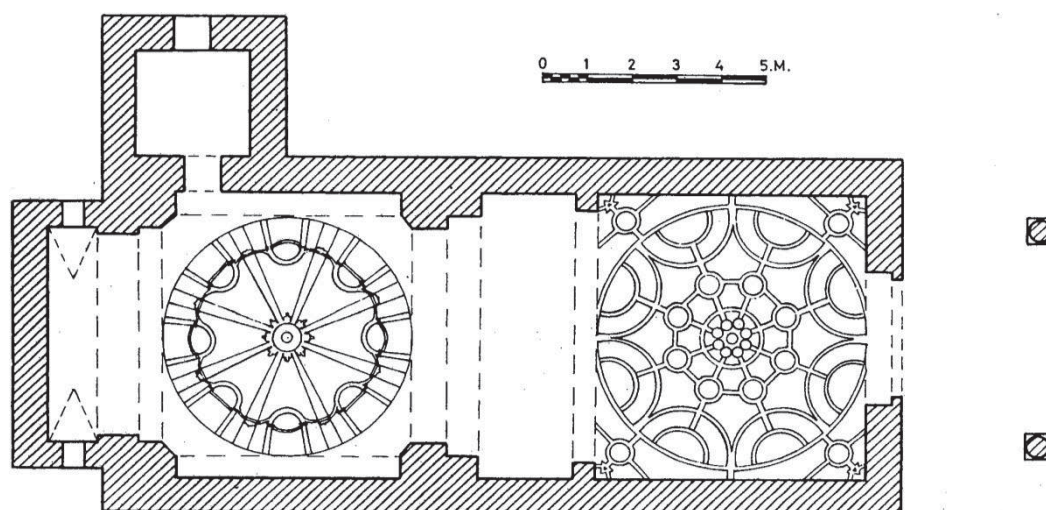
plano de la ermita de Tordesillas (fuente: ZALAMA RODRIGUEZ, M. A., Ermitas y santuarios..., p. 132)
